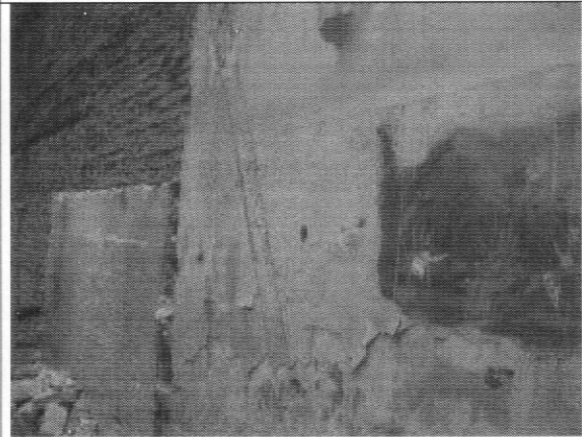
Fisuras en muros laterales de la parte frontal
